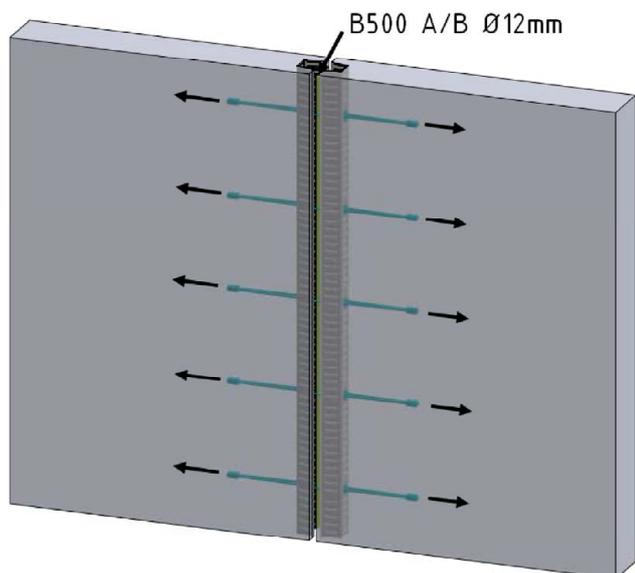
Zugbeanspruchung in Schlaufenlängsrichtung
